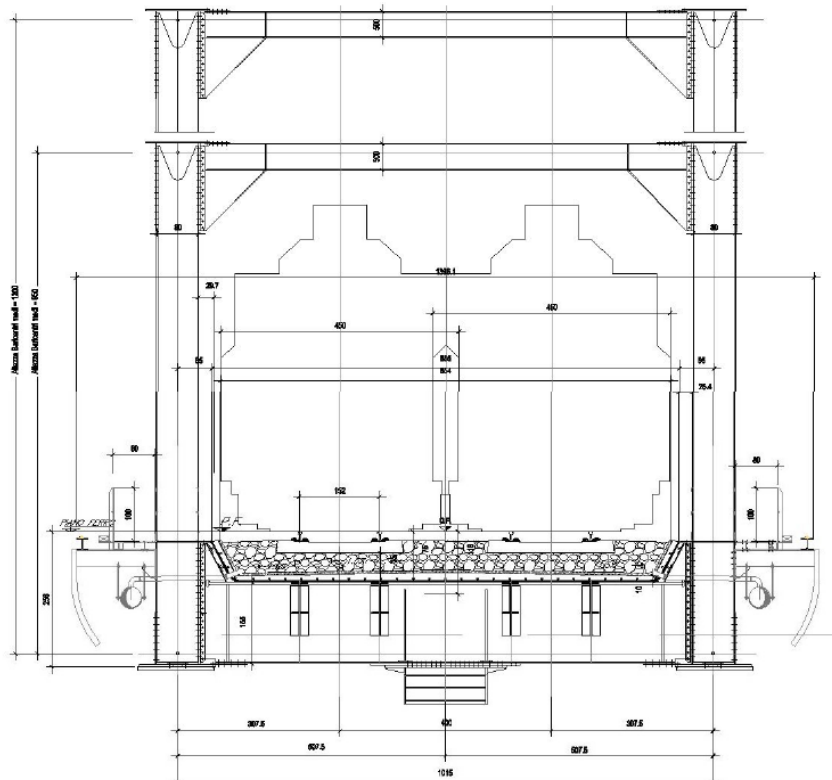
Sezione trasversale impalcato in acciaio da L=70m
